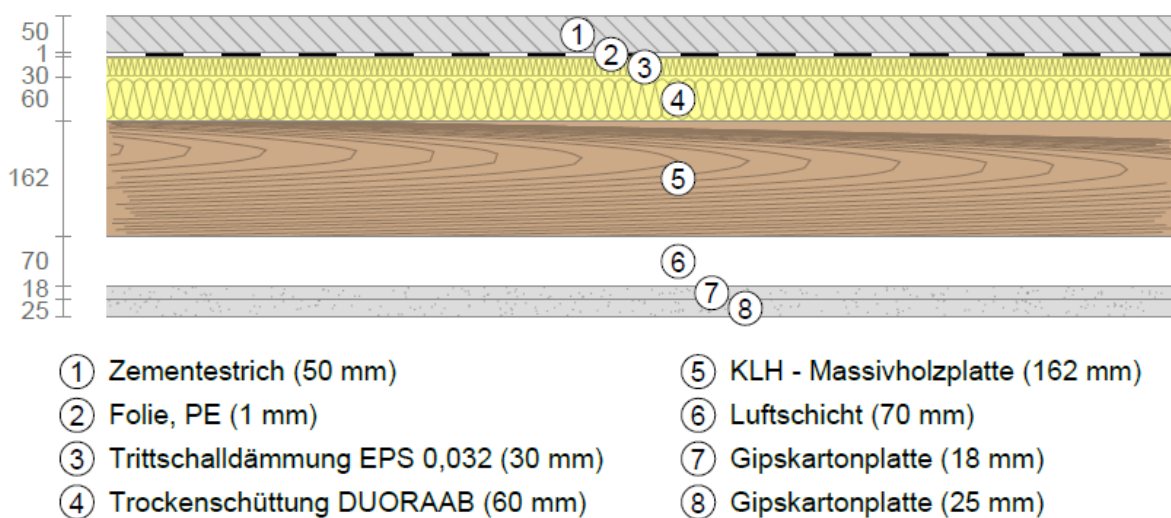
Deckenaufbau KLH-Decke WTD 01. Erstellt mit U-Wert.net
